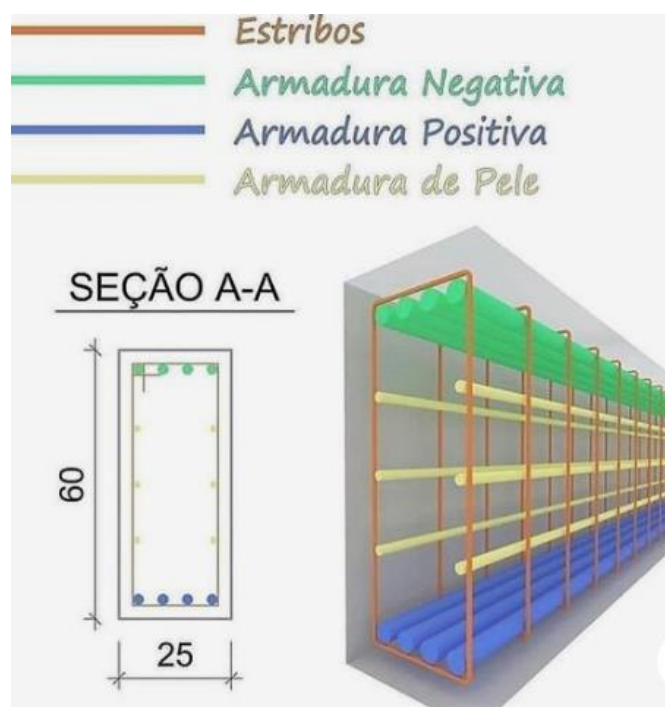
Secção transversal de uma viga (Fonte: Building How, 2003)
